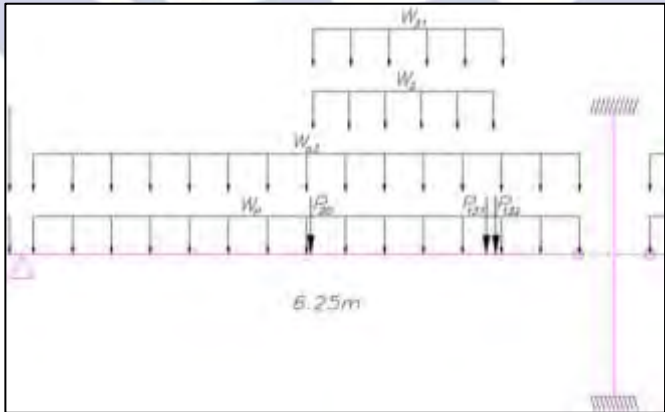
Distribución de carga muerta de la viga VT-7 (tramo 3)
